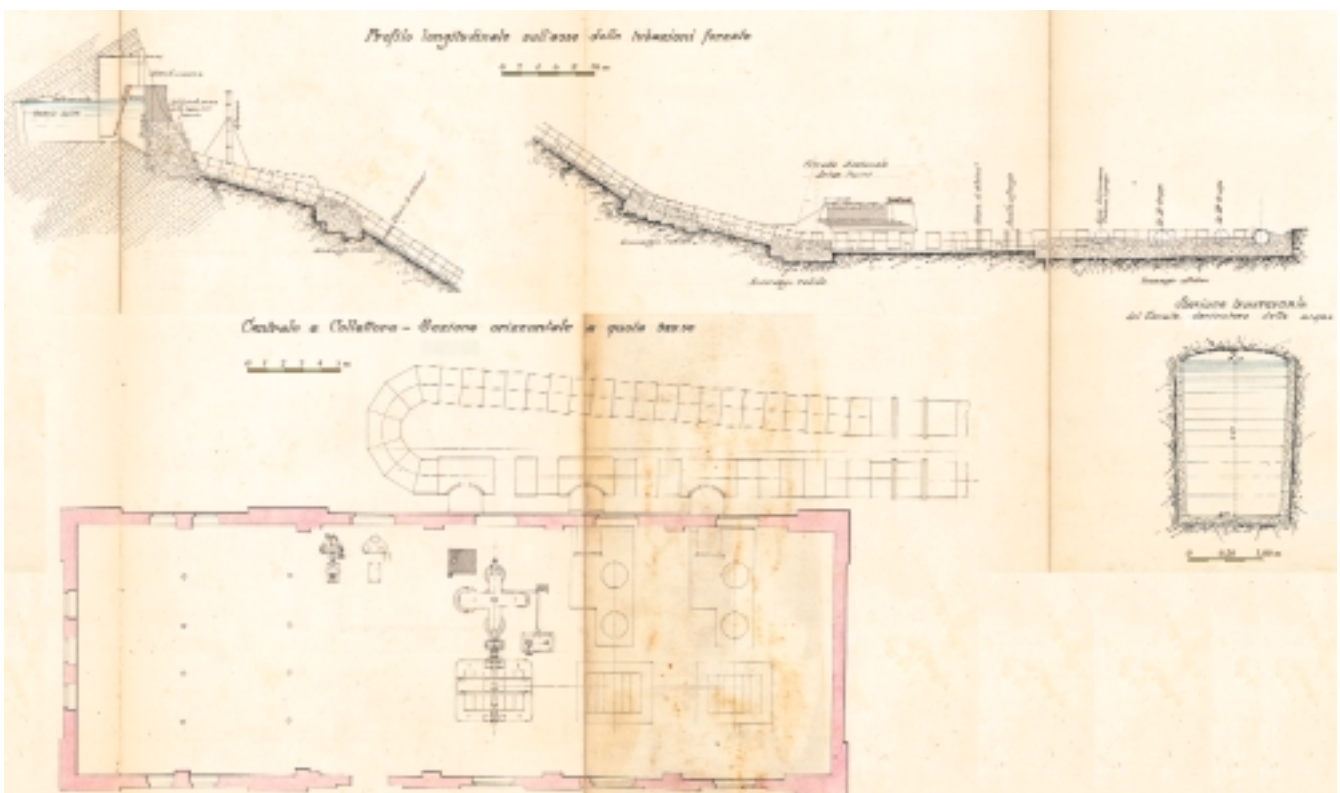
Impianto Ponte della Serra-Pedesalto: condotta forzata, pianta della centrale e sezione del canale di derivazione.
